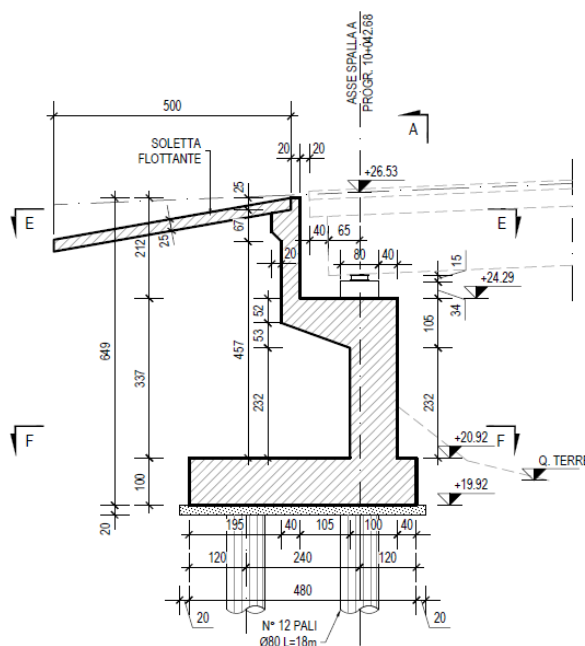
Sezione di carpenteria - Spalla tipo
